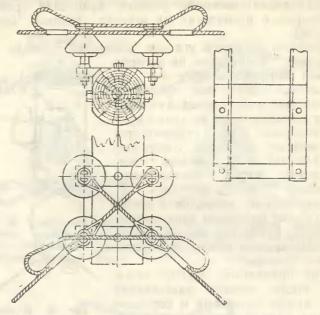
Одинарное усиленное угловое крепление провода на штыревых изоляторах на штырях угловой опоры.
